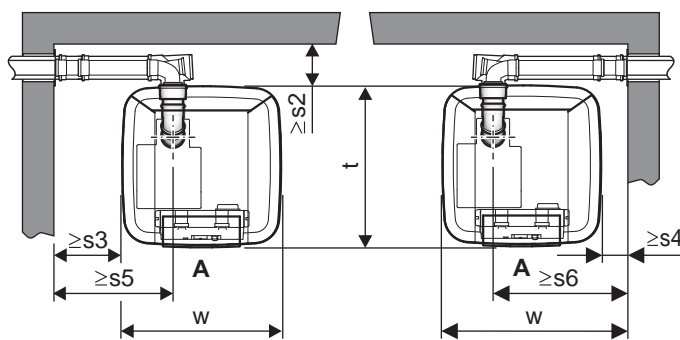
Vista dall'alto GCU compact raccordo fumi sul lato con SET K (v. sezione 4.5.3) - (dimensioni v. tab. 4-1)
